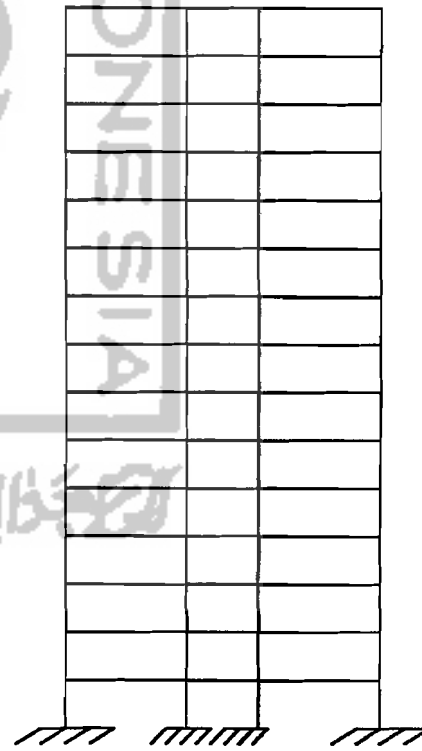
Denah penempatan struktur dinding-sepasang
